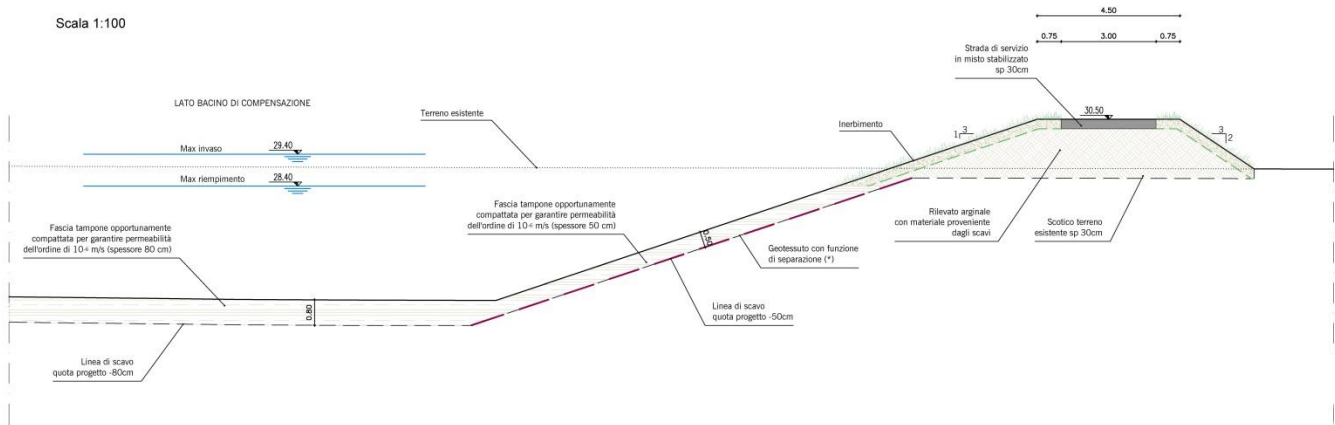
Sezione tipo del bacino di compensazione irrigua.
